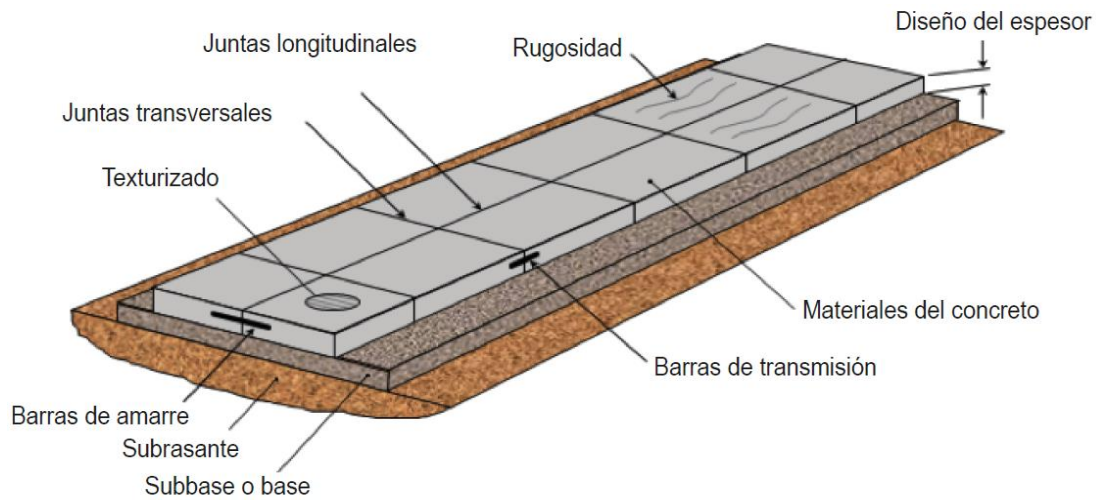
Componente estructural del pavimento rígido, por Calo, 2010.
